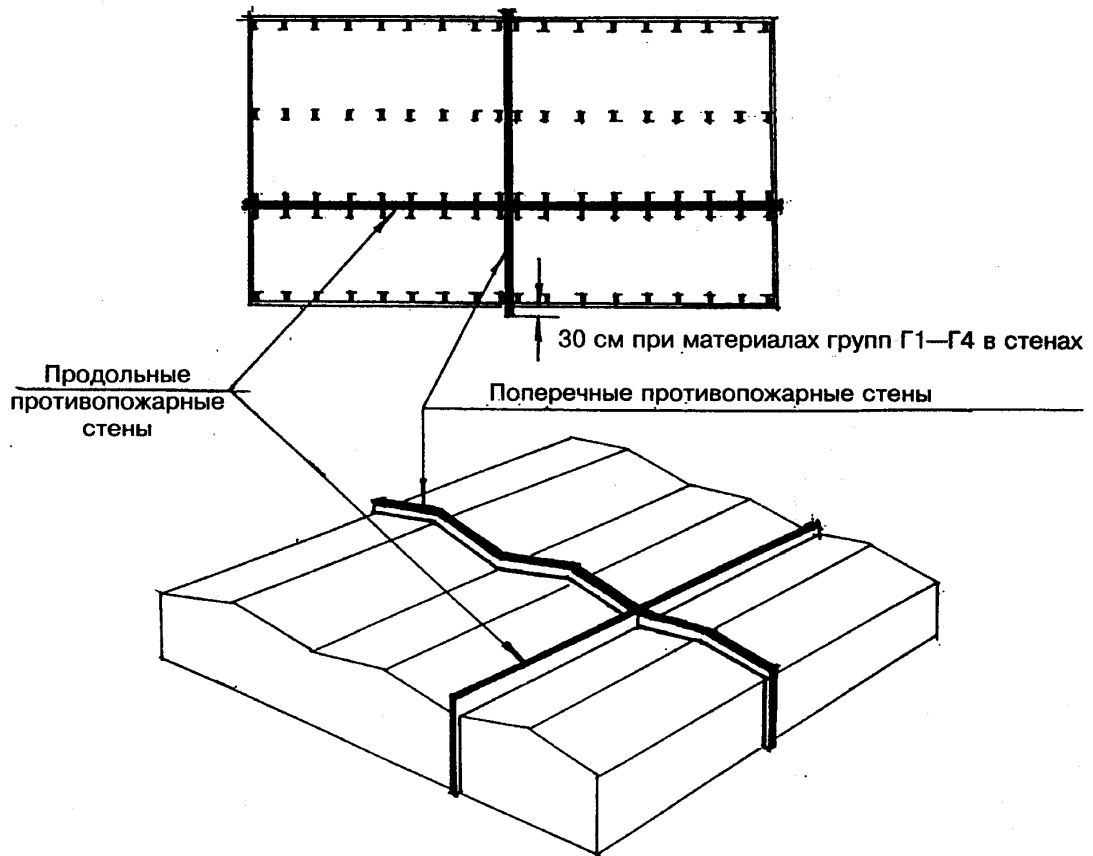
Разделение зданий на пожарные отсеки противопожарными стенами
